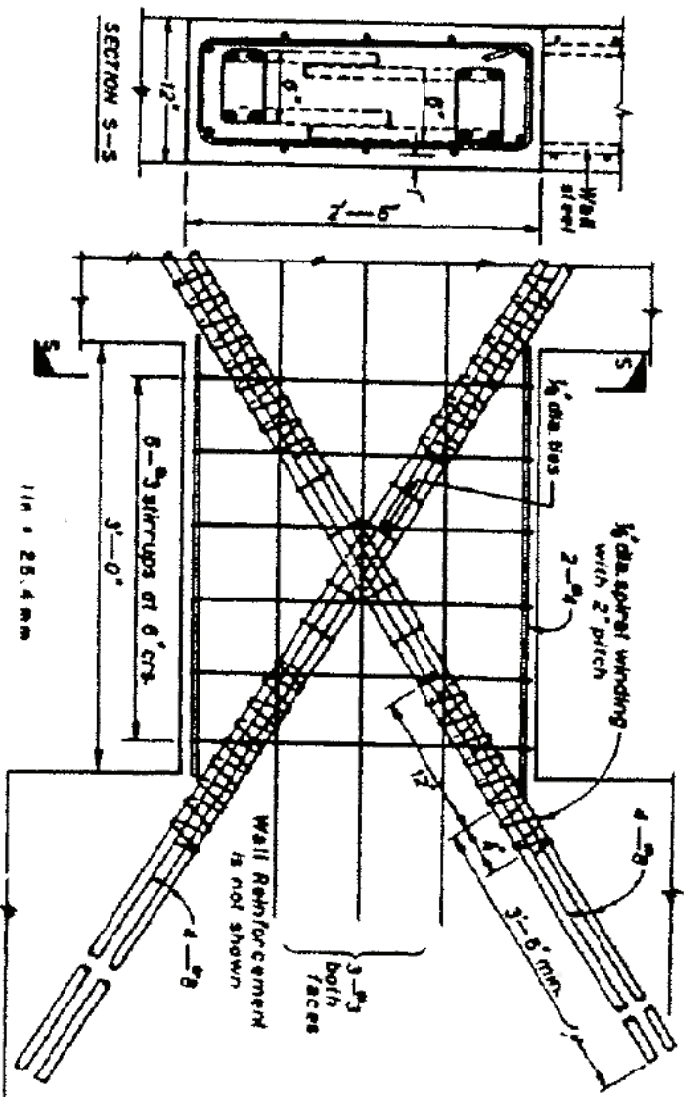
Suggerimento di disposizione armatura aggiuntiva nelle travi di collegamento
